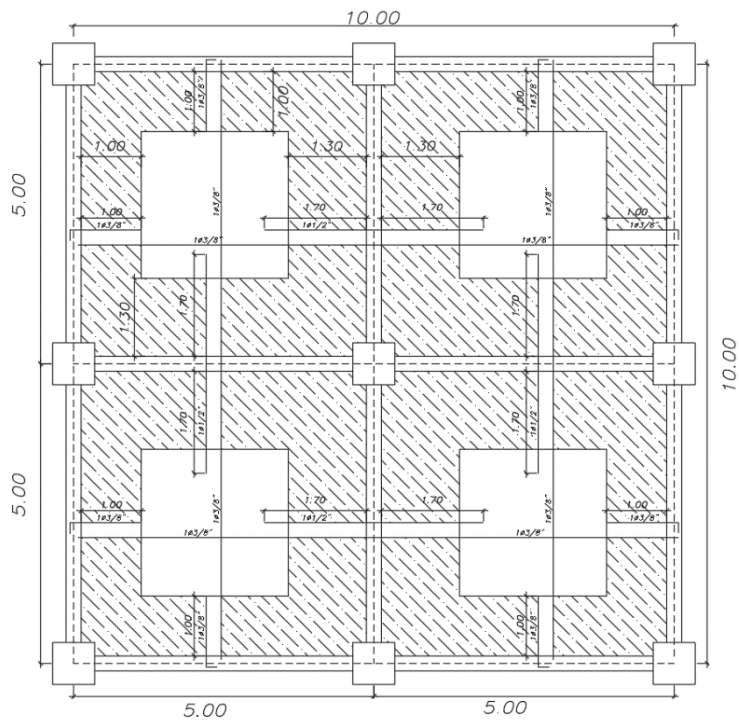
Distribución de acero en planta de losa aligerada bidireccional
